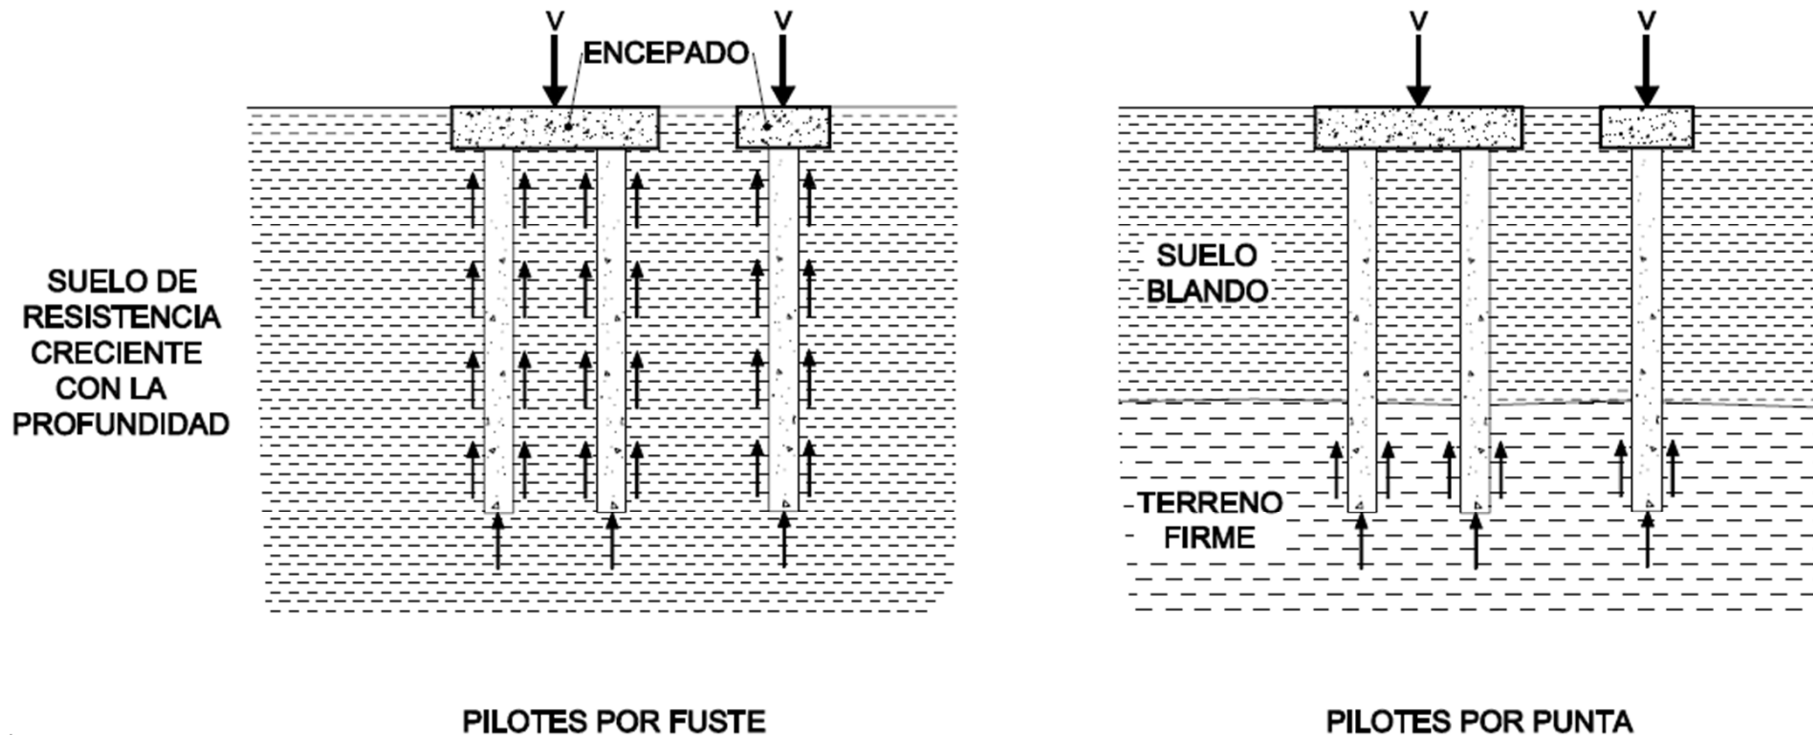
Esquema de cimentaciones profundas (pilotes)
